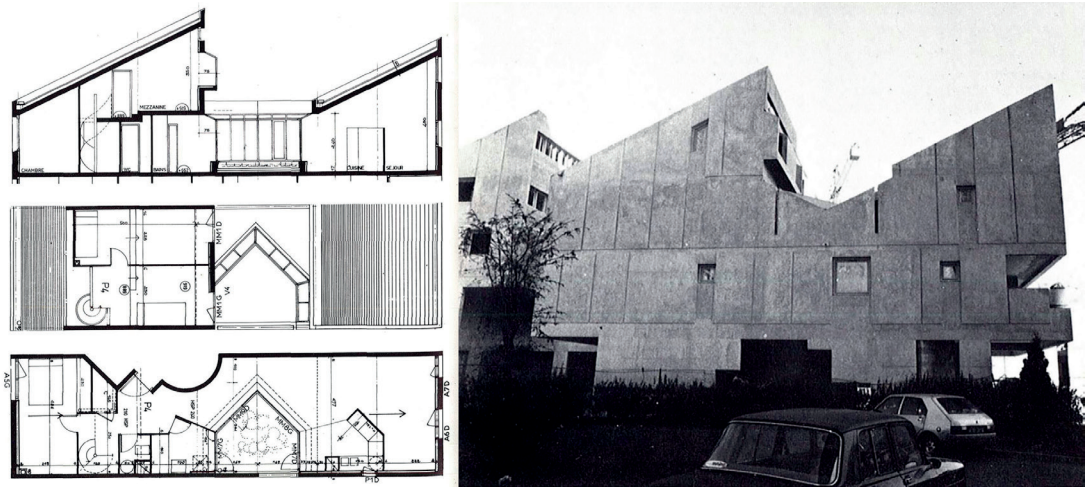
Plantas y sección de vivienda en el complejo *Fontaine* en Villejuif (1981).
